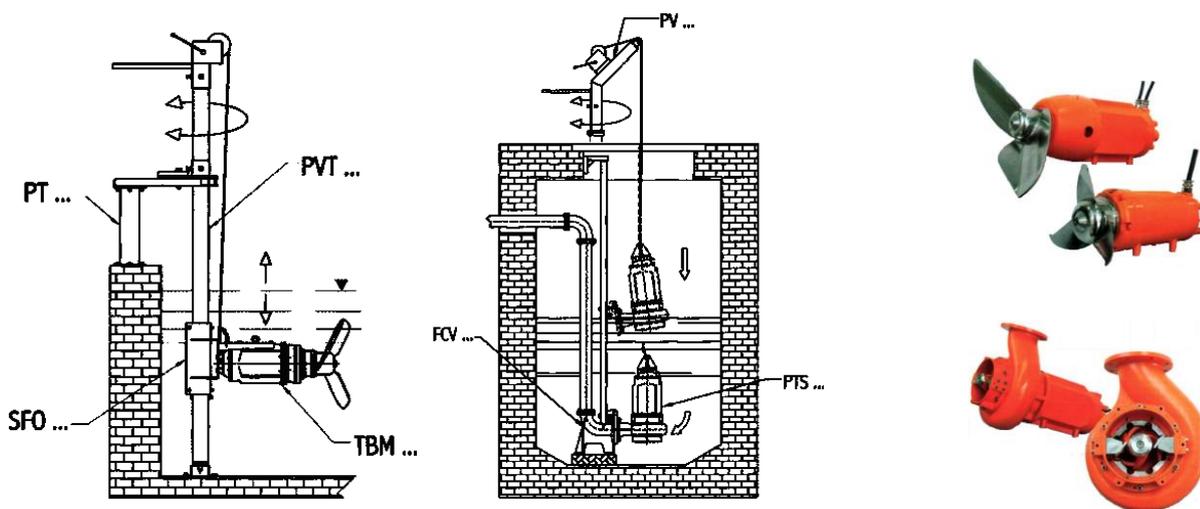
Схема насосной станции с погружными насосами и мешалкой
